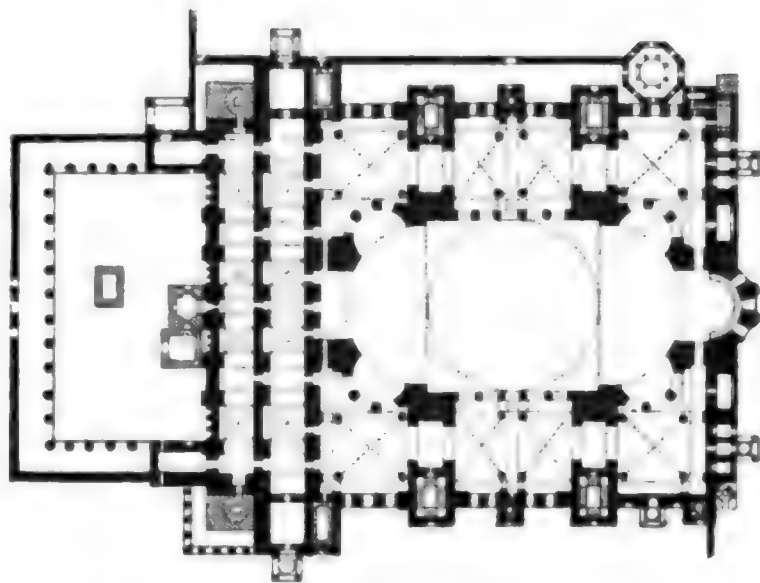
Planta de Santa Sofía. CONSTANTINOPLA.
